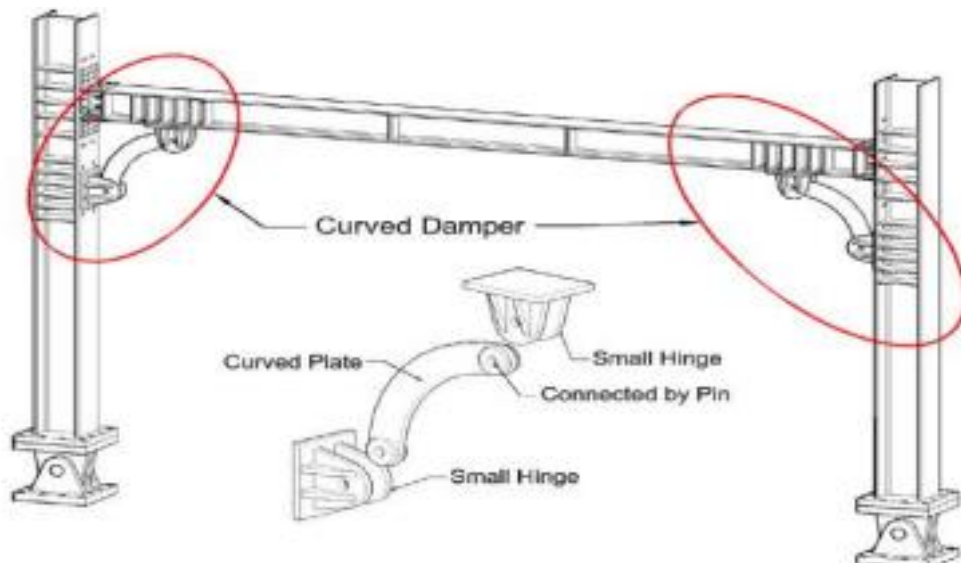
Disipadores de metal acoplados en los pórticos de estructura metálica
